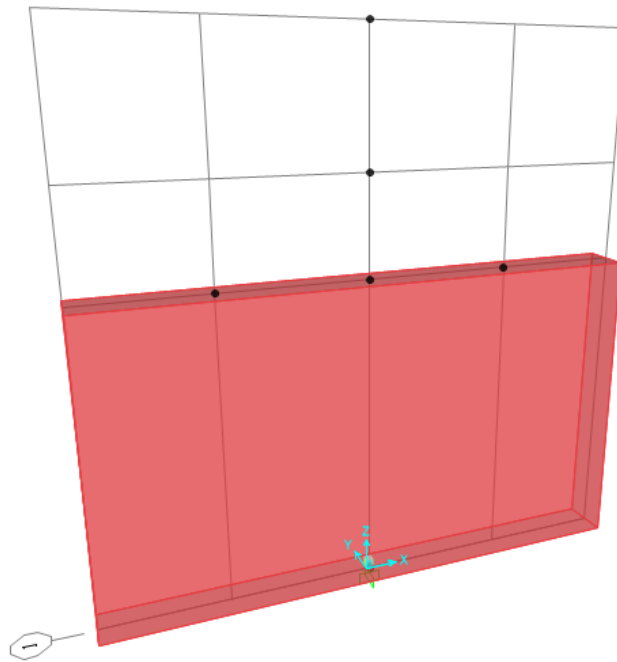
Modelo tipo Frame para Pila tipo muro SAP2000.
